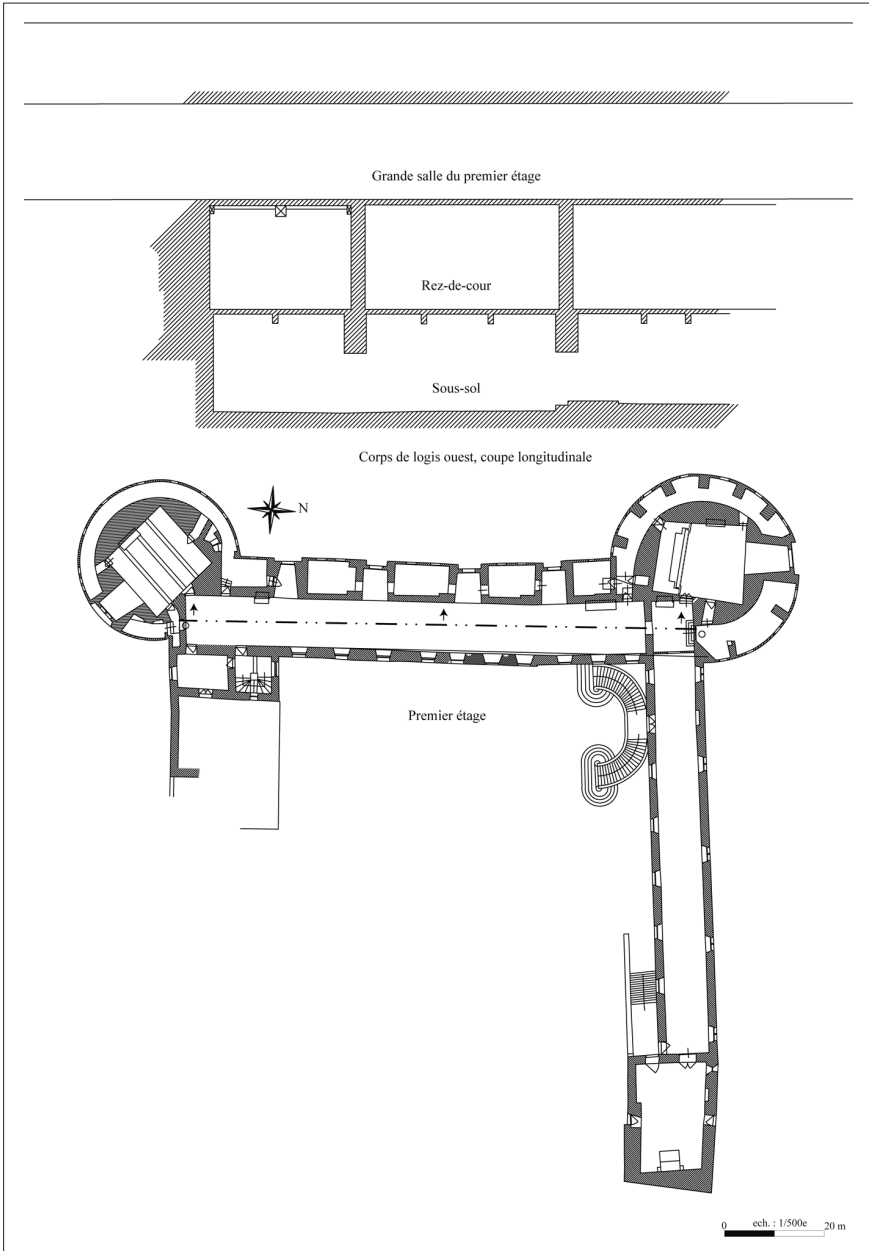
Pontivy, plan de l'étage et coupe du logis ouest (DAO Jocelyn Martineau, 2009, d'après plan topographique levé par la ville de Pontivy, 2002)
